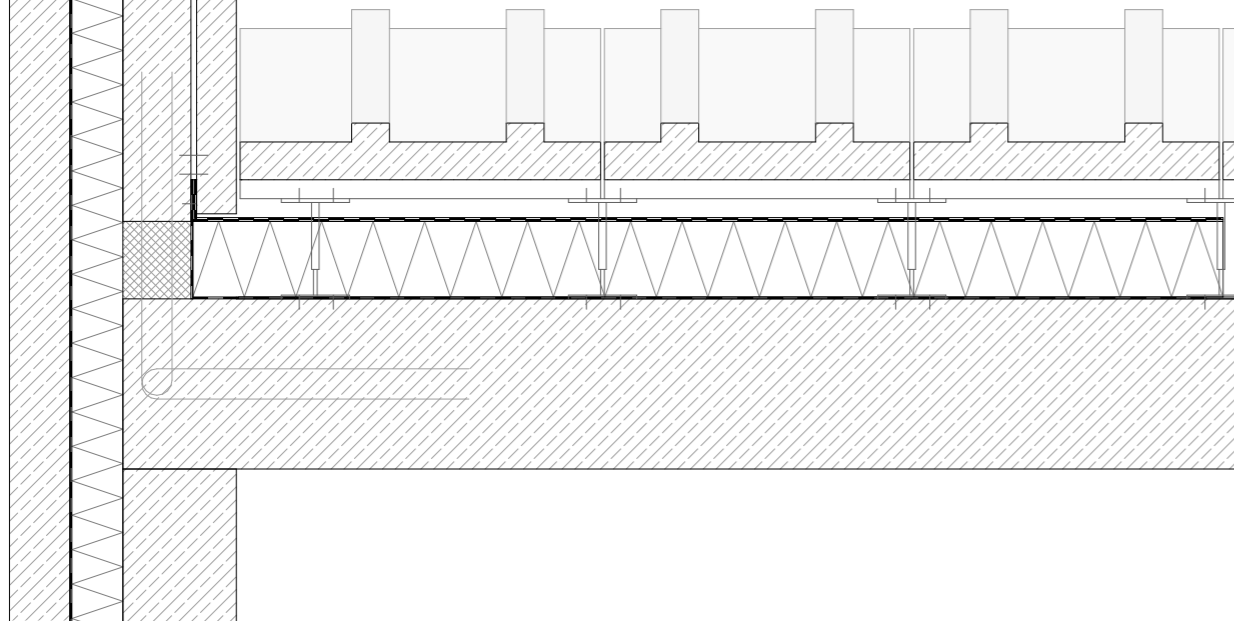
DETAILANSICHT SÜD _ KULTURZENTRUM M 1_20
